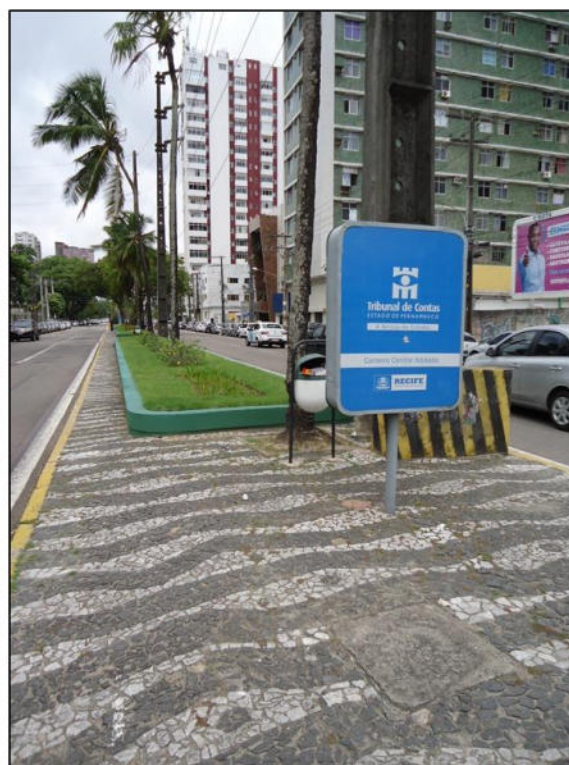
Pavimento em Intertravado / Figura 9 – Canteiro em Pedra Portuguesa
